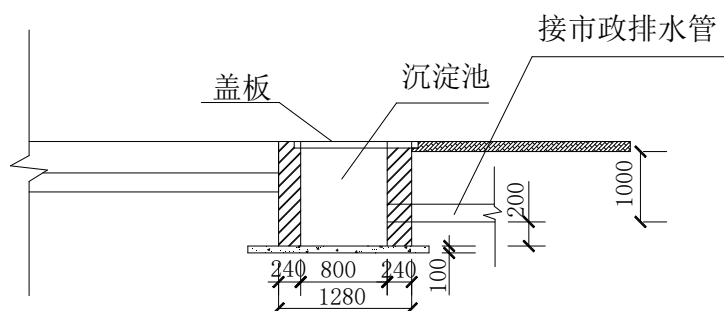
沉淀池剖面图（图中单位为 mm）
